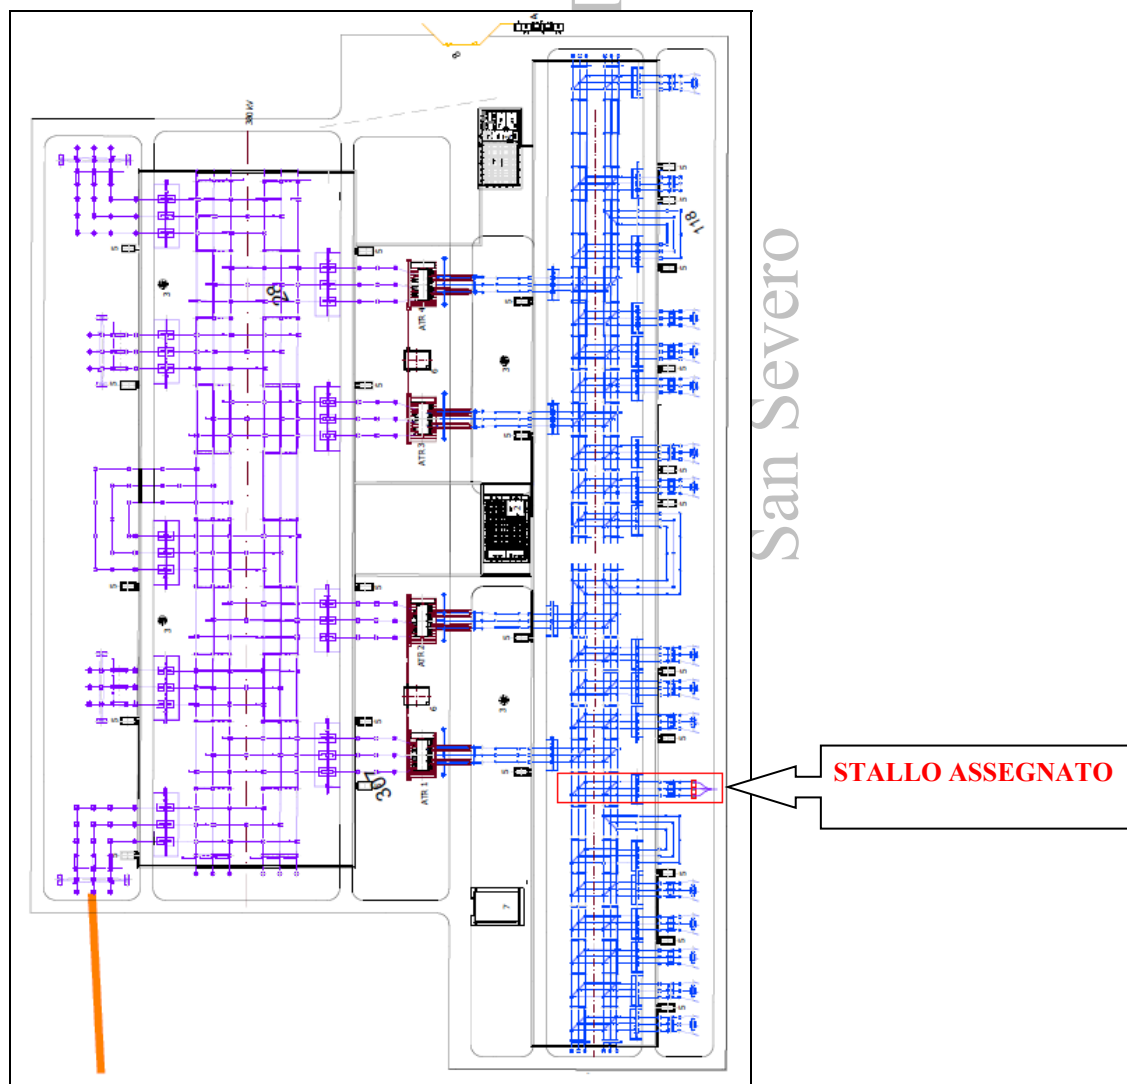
Stralcio planimetrico elettromeccanico della SE di Cerignola con indicazione dello stallo condiviso
